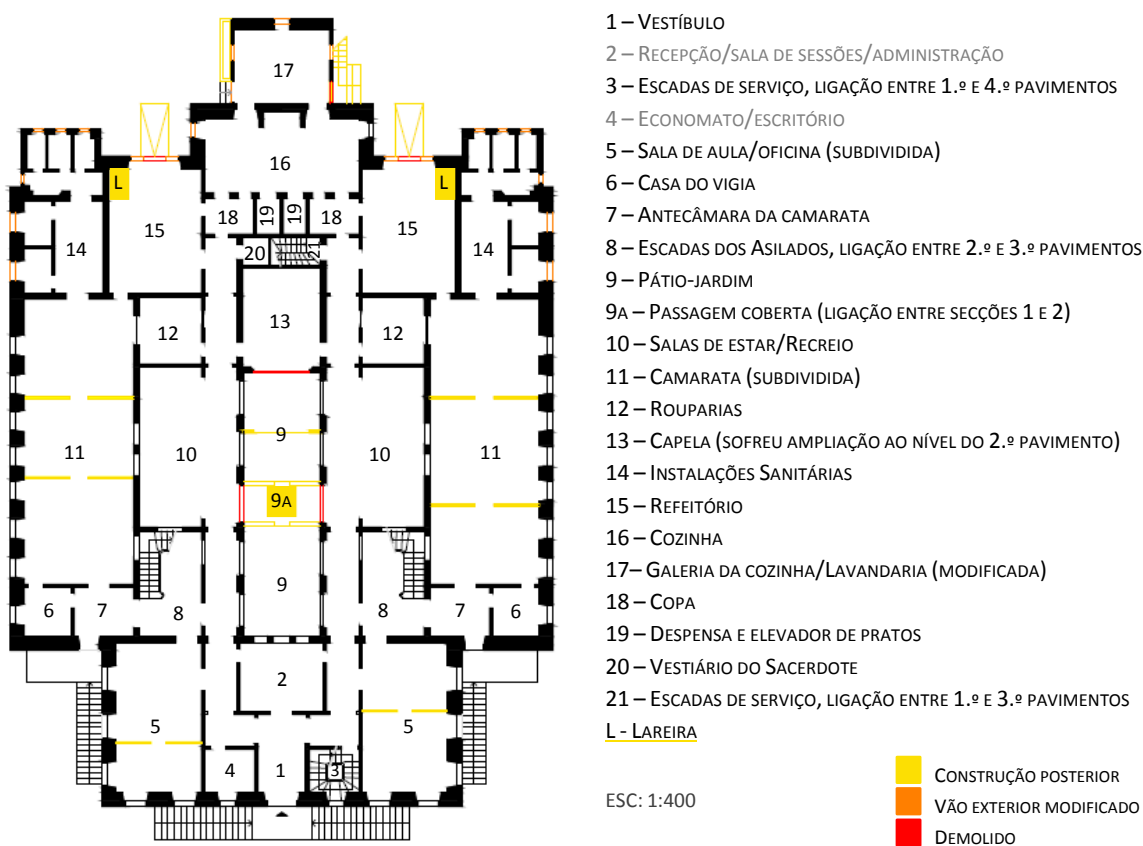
Proposta de reconstituição do 2.º pavimento, em 1916
